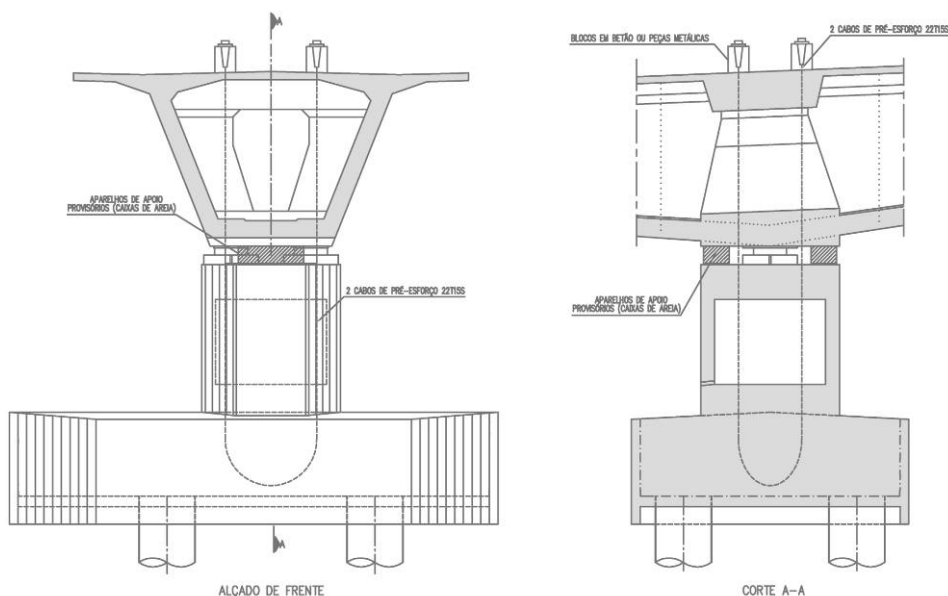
Sistema de equilíbrio das consolas em fase construtiva
